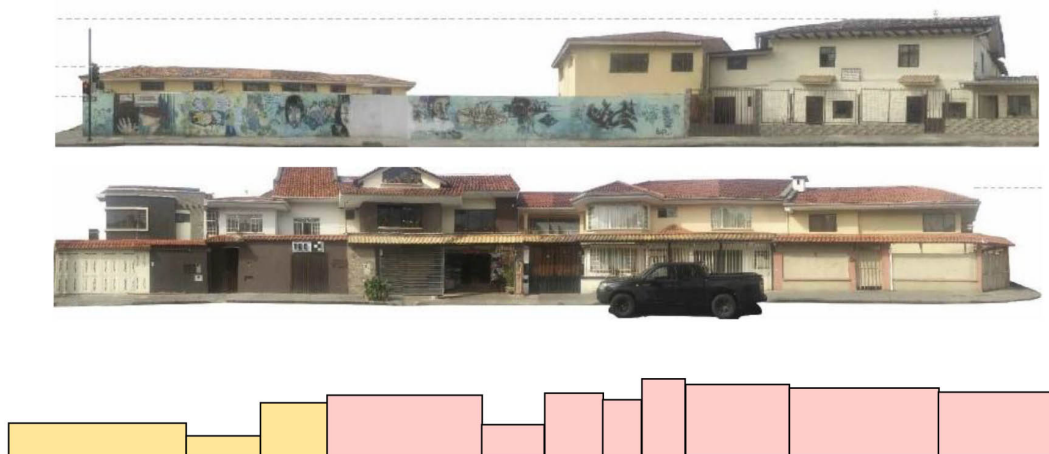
Tramo 4 de la calle del Arupo con vista en dirección Sur
